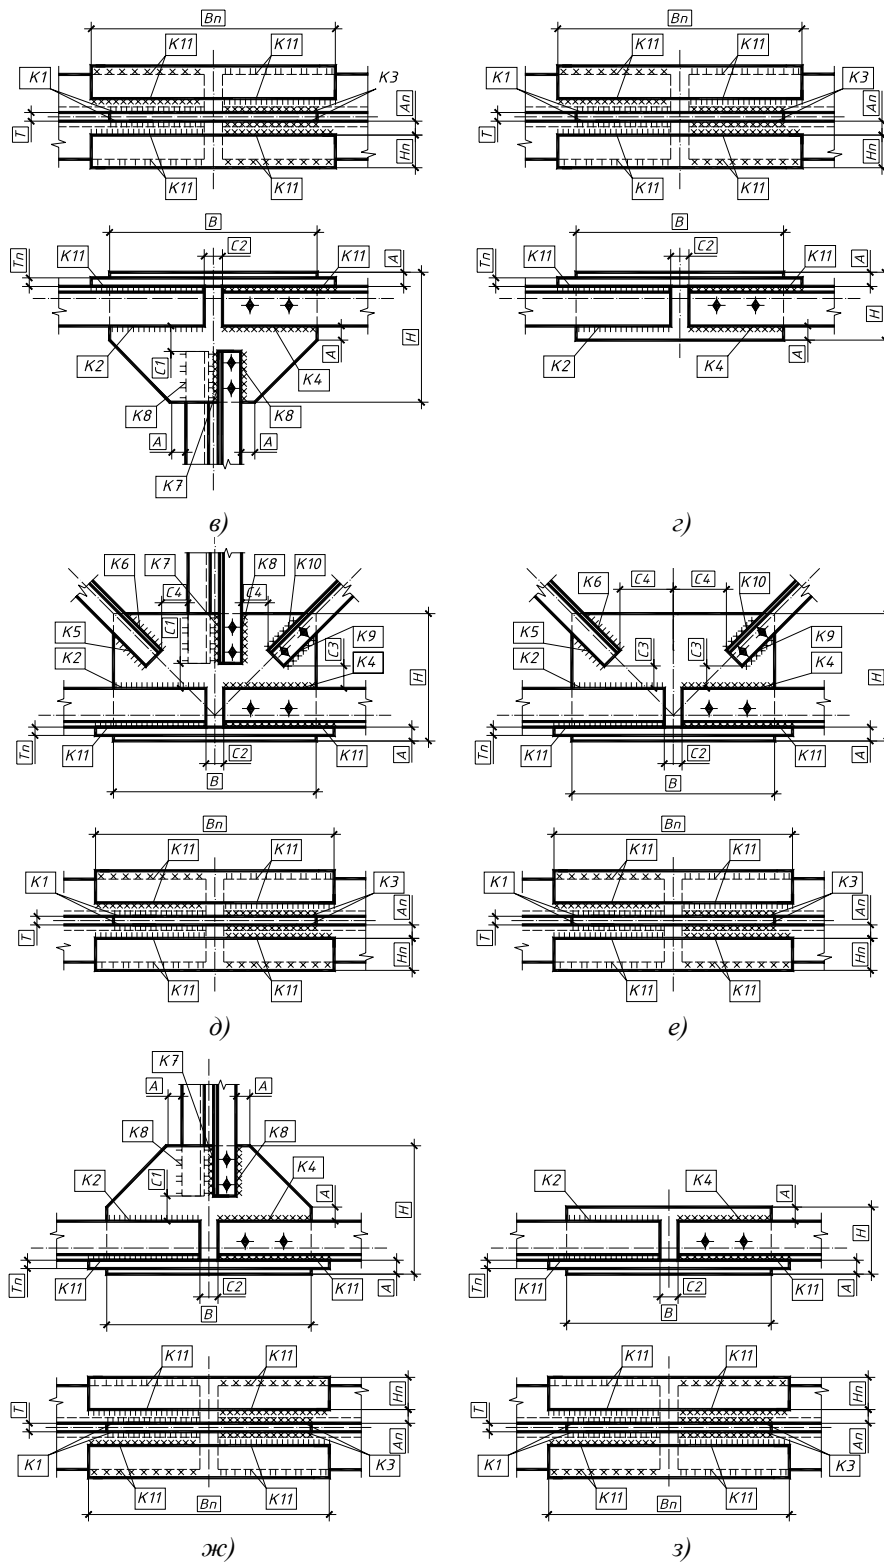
Монтажные узлы в фермах из спаренных уголков
